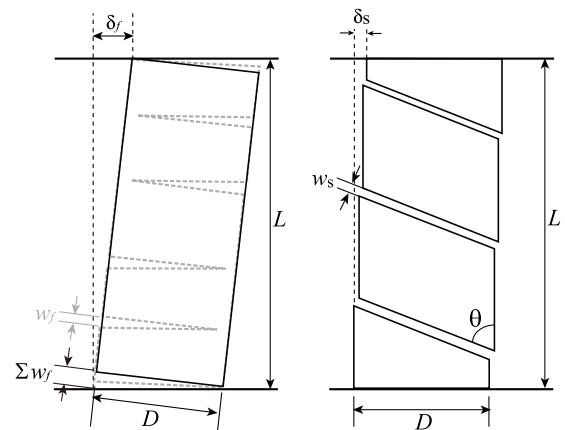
幾何学的なひび割れ-変形モデル⁸⁾
